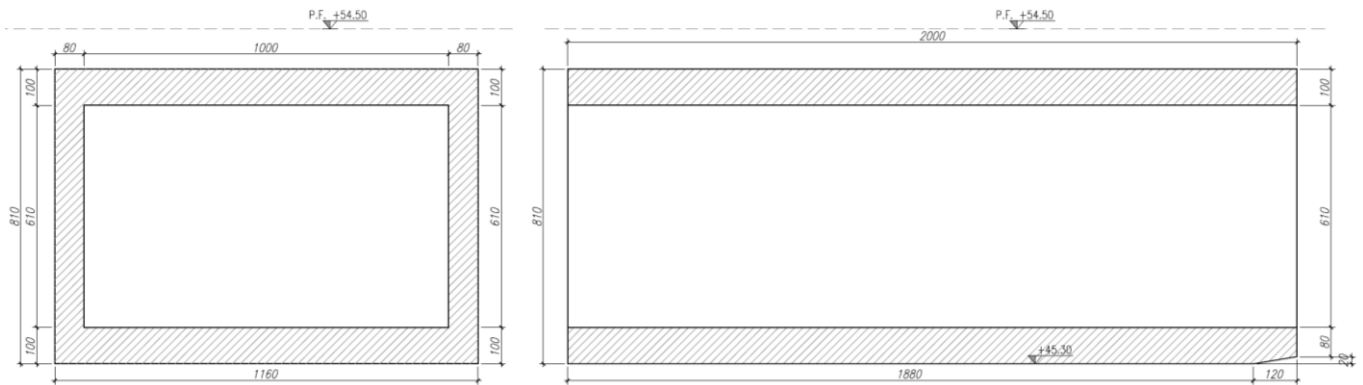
Sezione trasversale e sezione longitudinale del manufatto
